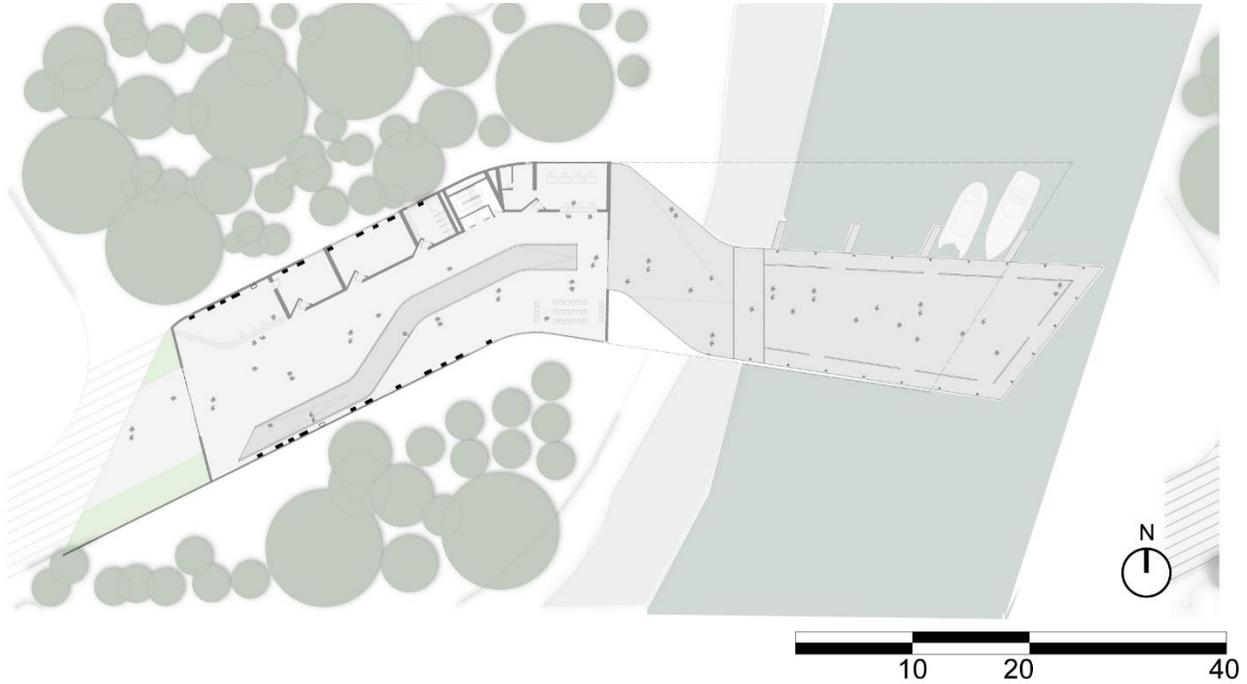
Intervención arquitectónica: “Muelle-Museo-Mirador”, planta baja.
